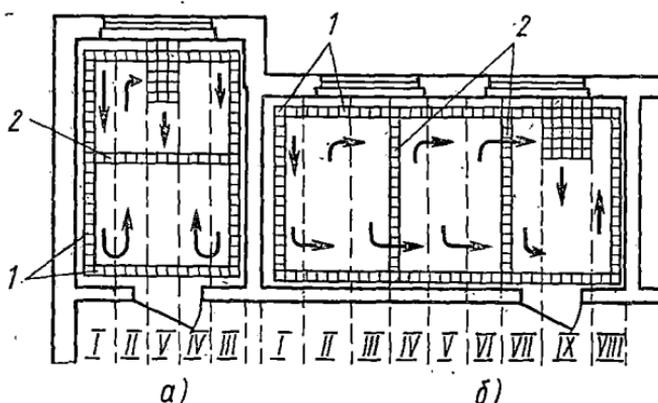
Разбивка пола на захватки в помещениях с окнами в торцевой стене (*a*) и в продольной (*б*) стенах:
